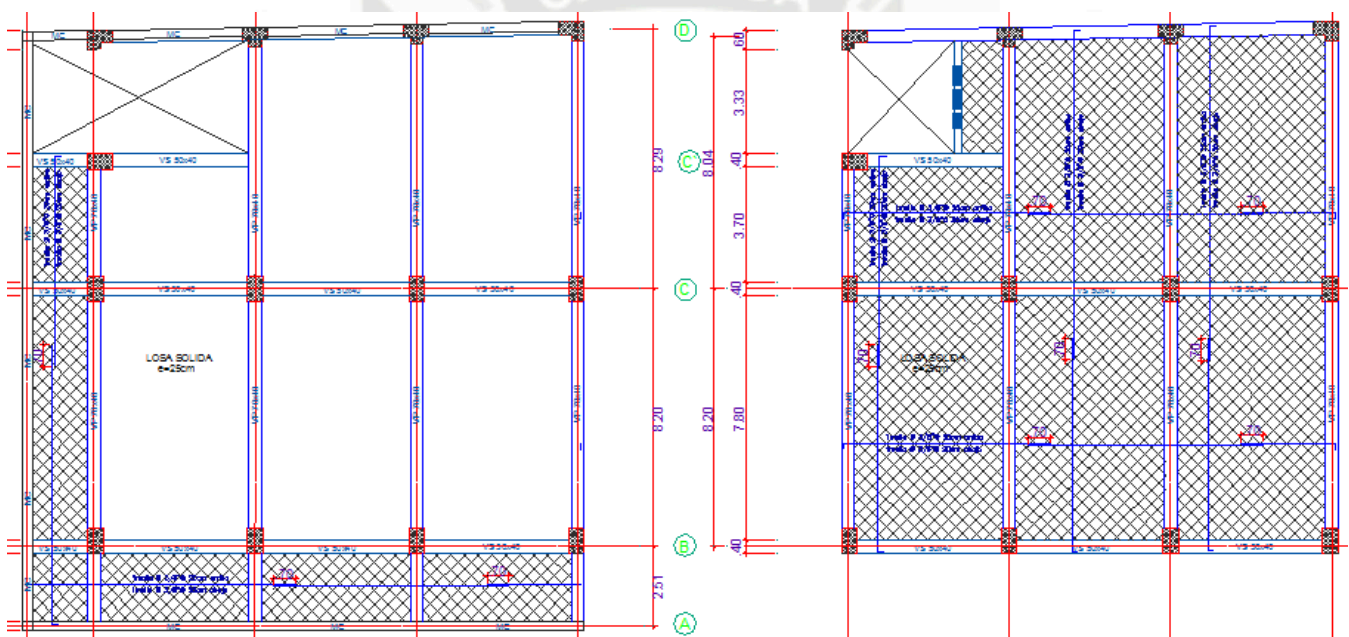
c. Interfase de aislación (ente ambas losas van los aisladores)
